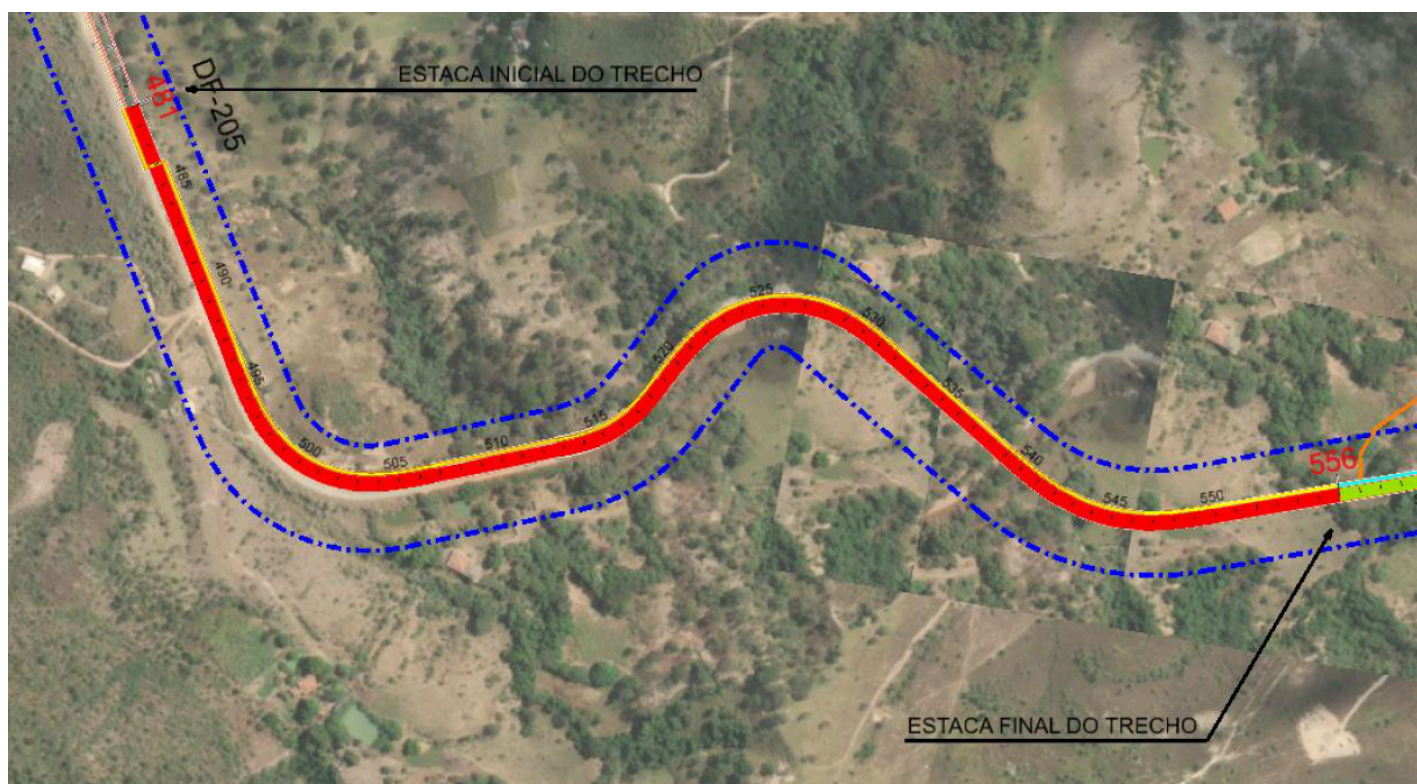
Trecho a ser pavimentado (Fonte: Projeto de Pavimentação do DER-DF)
